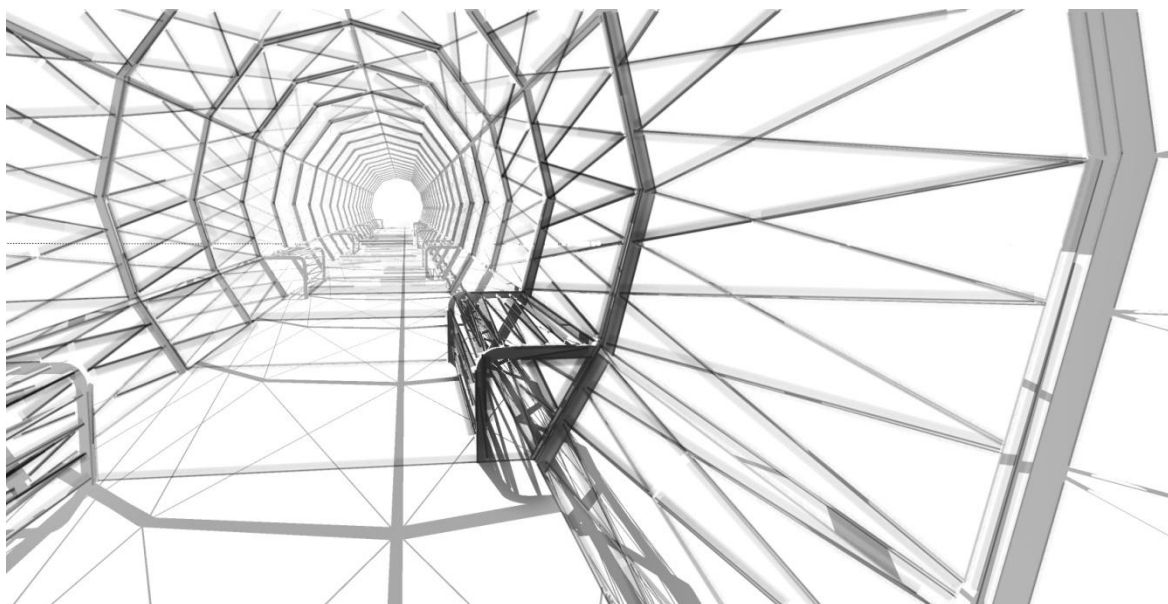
Detail výpletu vrchní části konstrukce lávky
